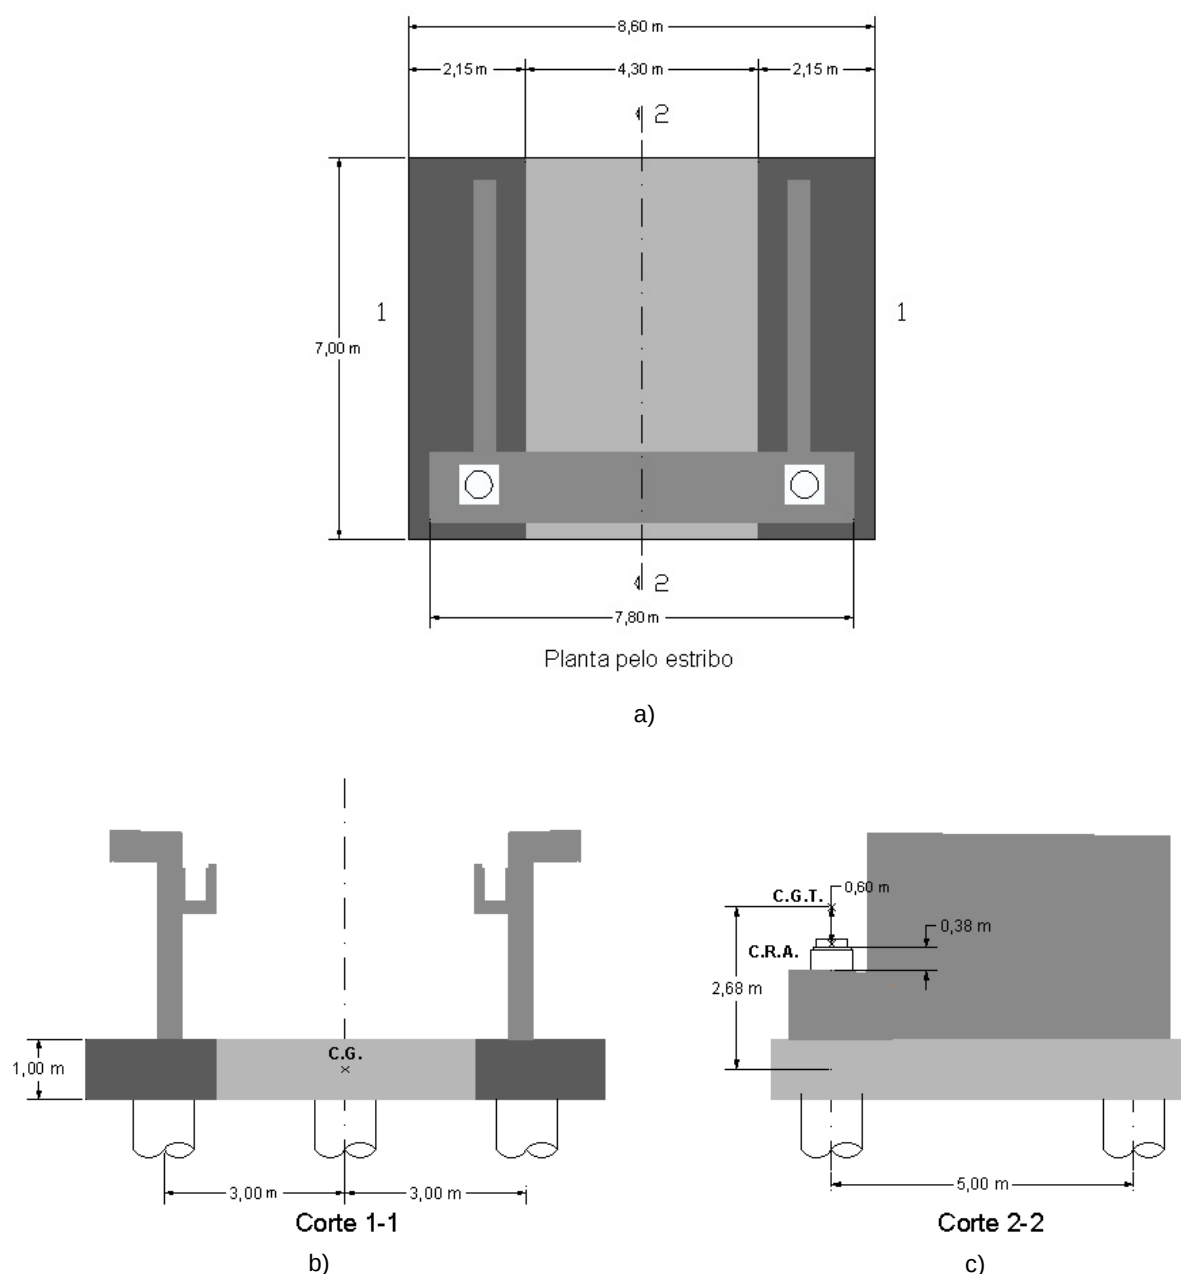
Geometria do encontro E2: a) planta pelo estribo; b) corte 1-1; c) corte 2-2.
